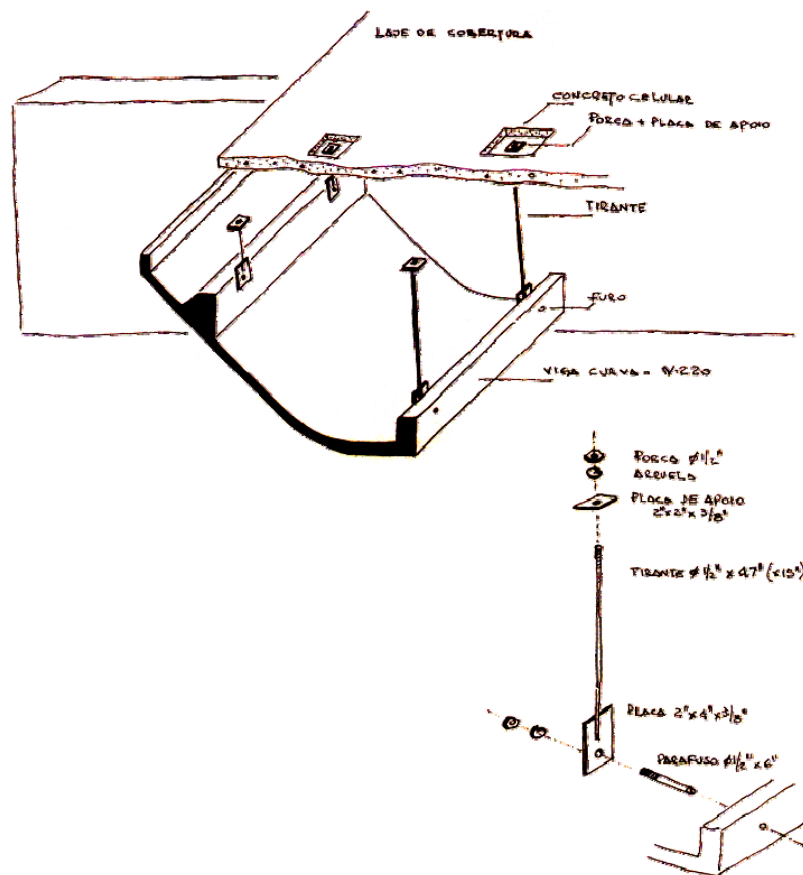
Croqui do reforço de fixação das platibandas do ICC (Walter Vilhena, 1992)
